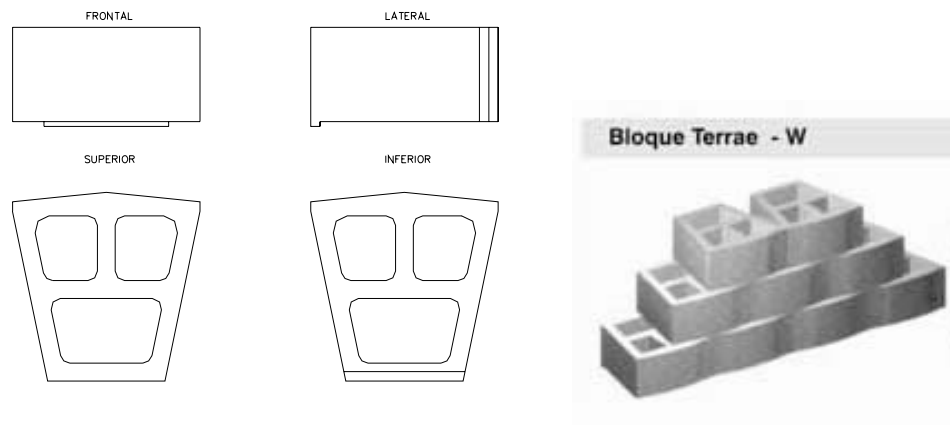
Planta, corte y vista de los bloques premoldeados
